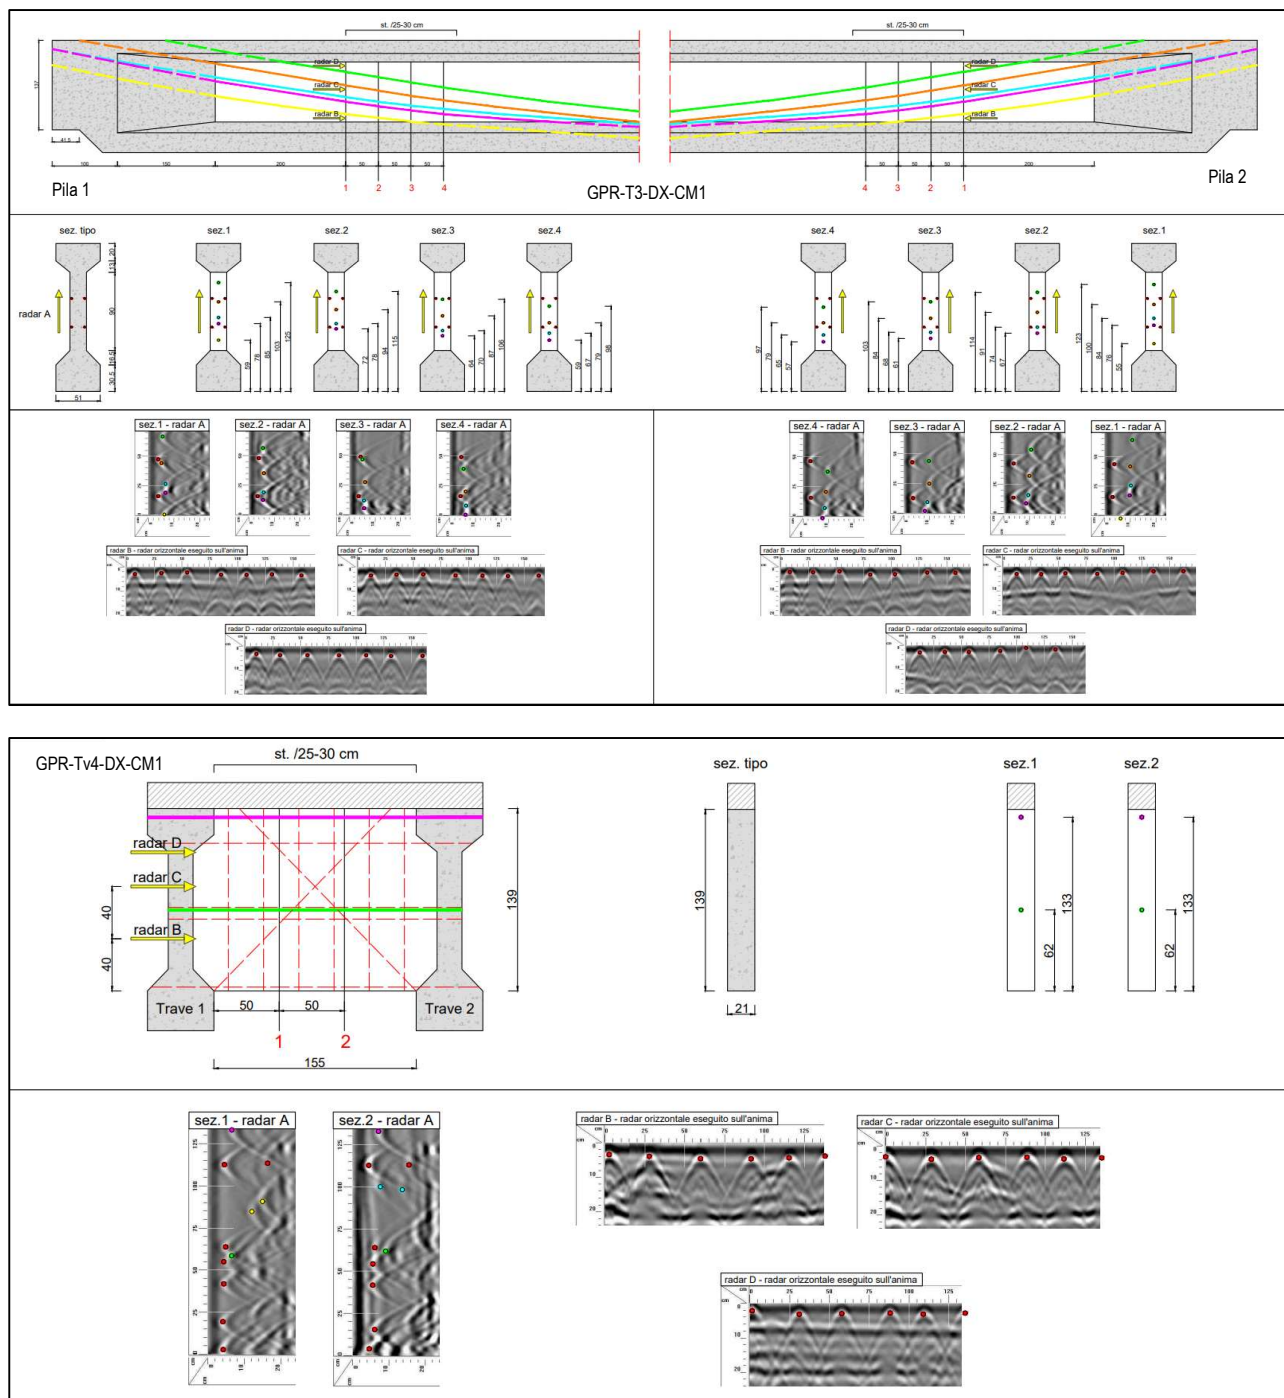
Identificazione del sistema di precompressione – Esempio ubicazione sezioni e zone di rilievo con posizionamento armatura di precompressione (es. travi e traversi post-tesi)
